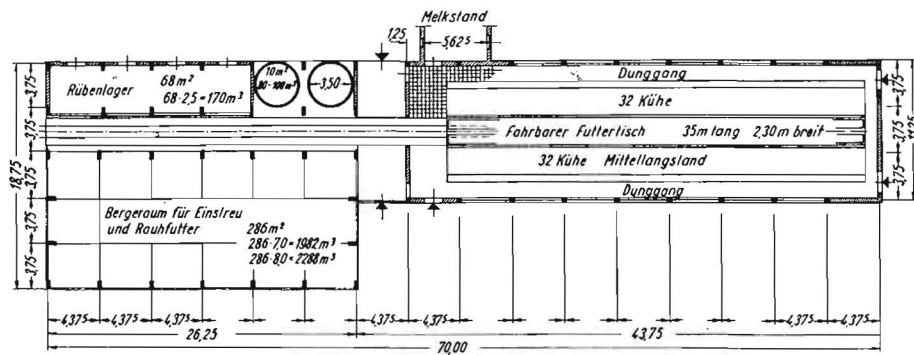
Grundriß des Kuhstalles mit erdlastigem Bergeraum
